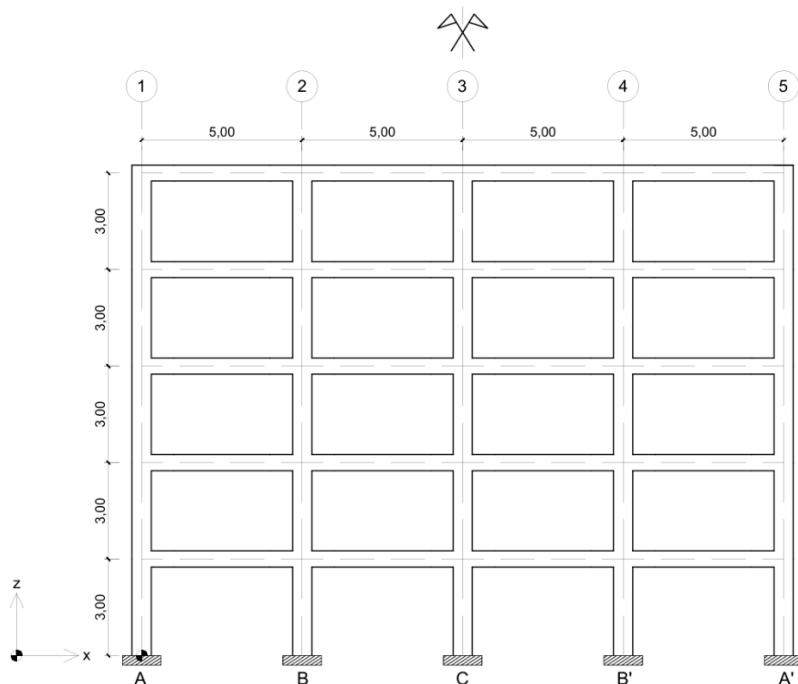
Sezione strutturale dell'edificio iniziale (quote espresse in metri)
